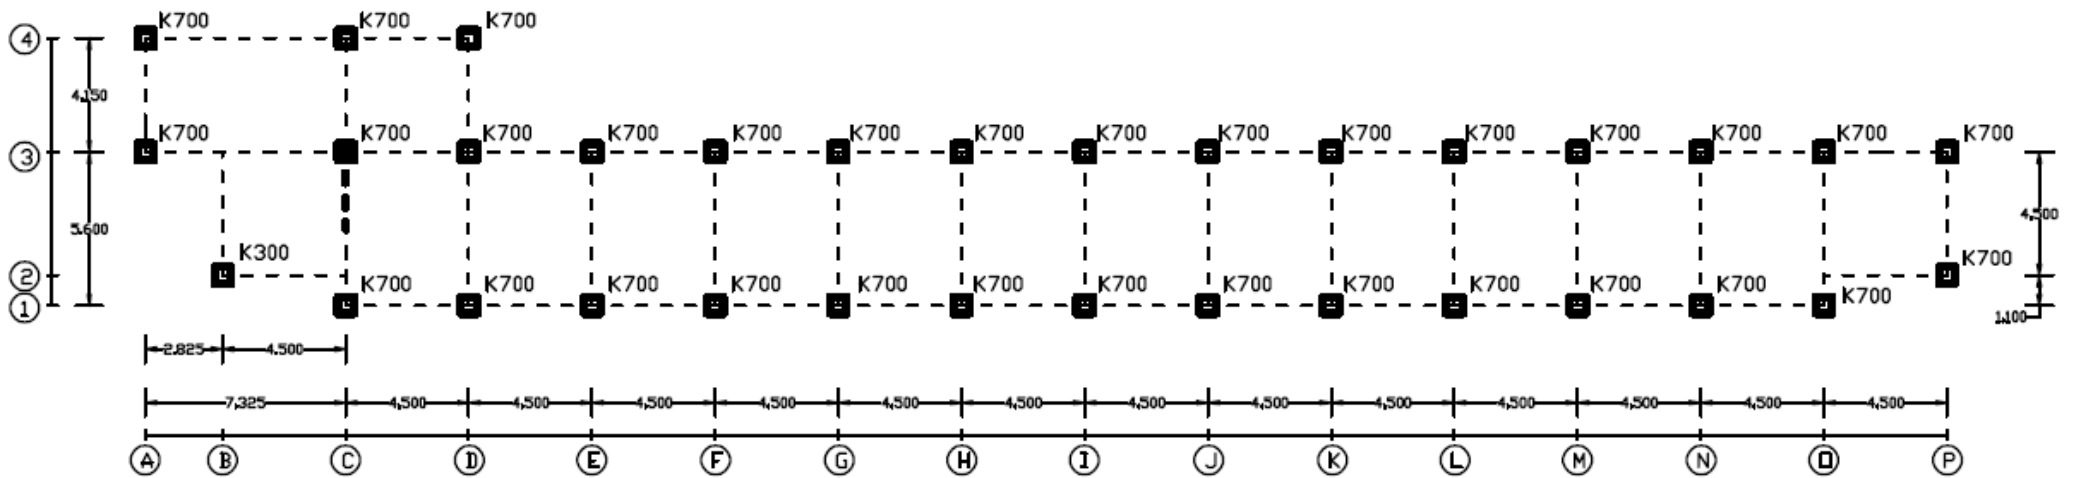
Denah Balok Lantai 5 (Lantai Atas)
